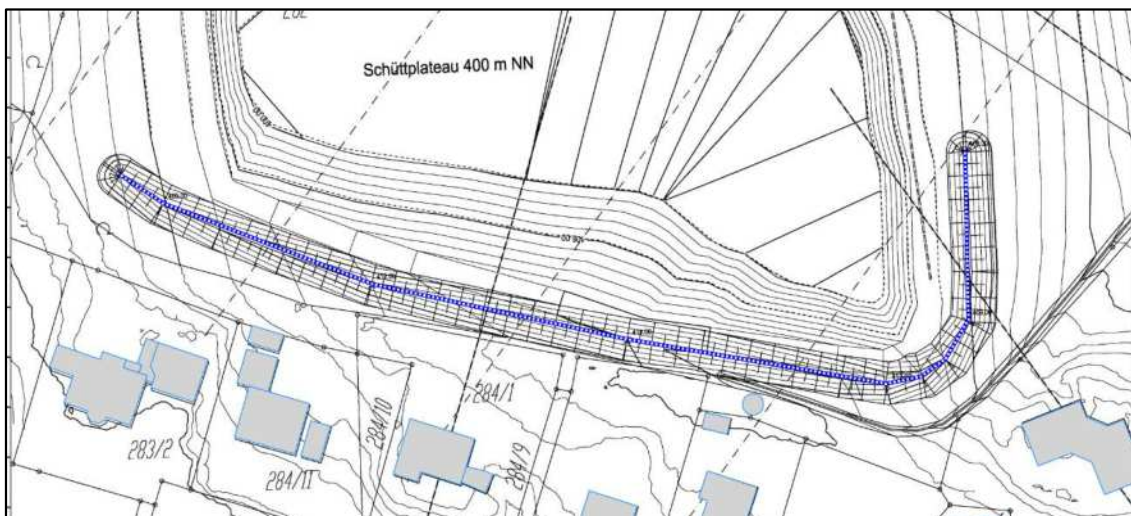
Lageplan mit Darstellung des Lärmschutzwalls für Ebene 2
